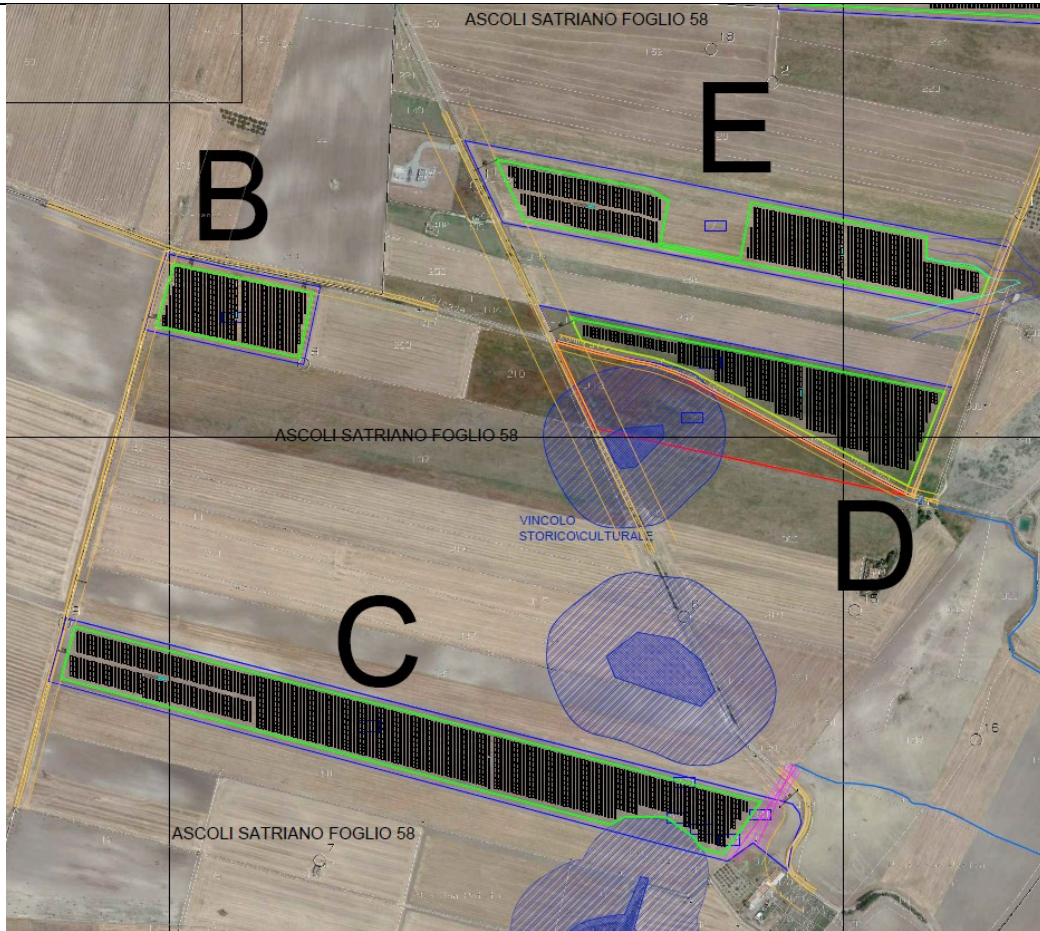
Layout di impianto dell’Area B, C, D ed E
